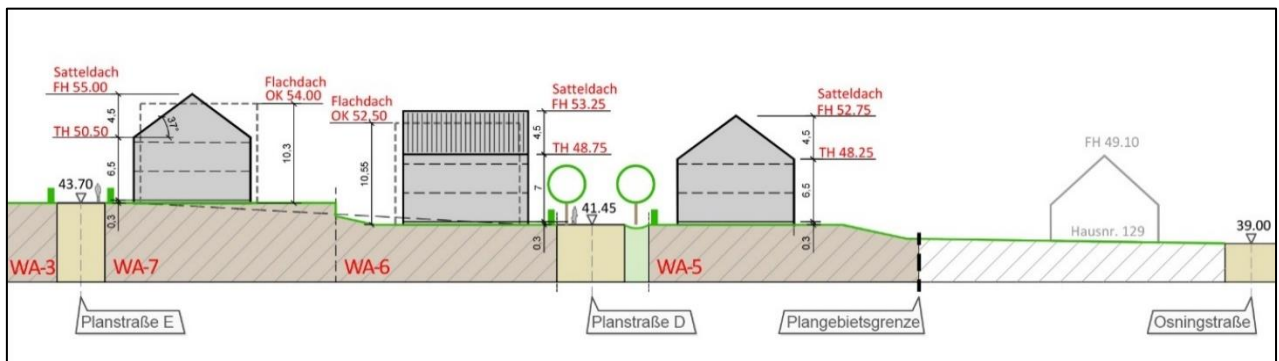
Systemschnitt Planstraße E/Planstraße D – Blickrichtung Ost (Mai 2025 - StadtQuadrat GmbH)
